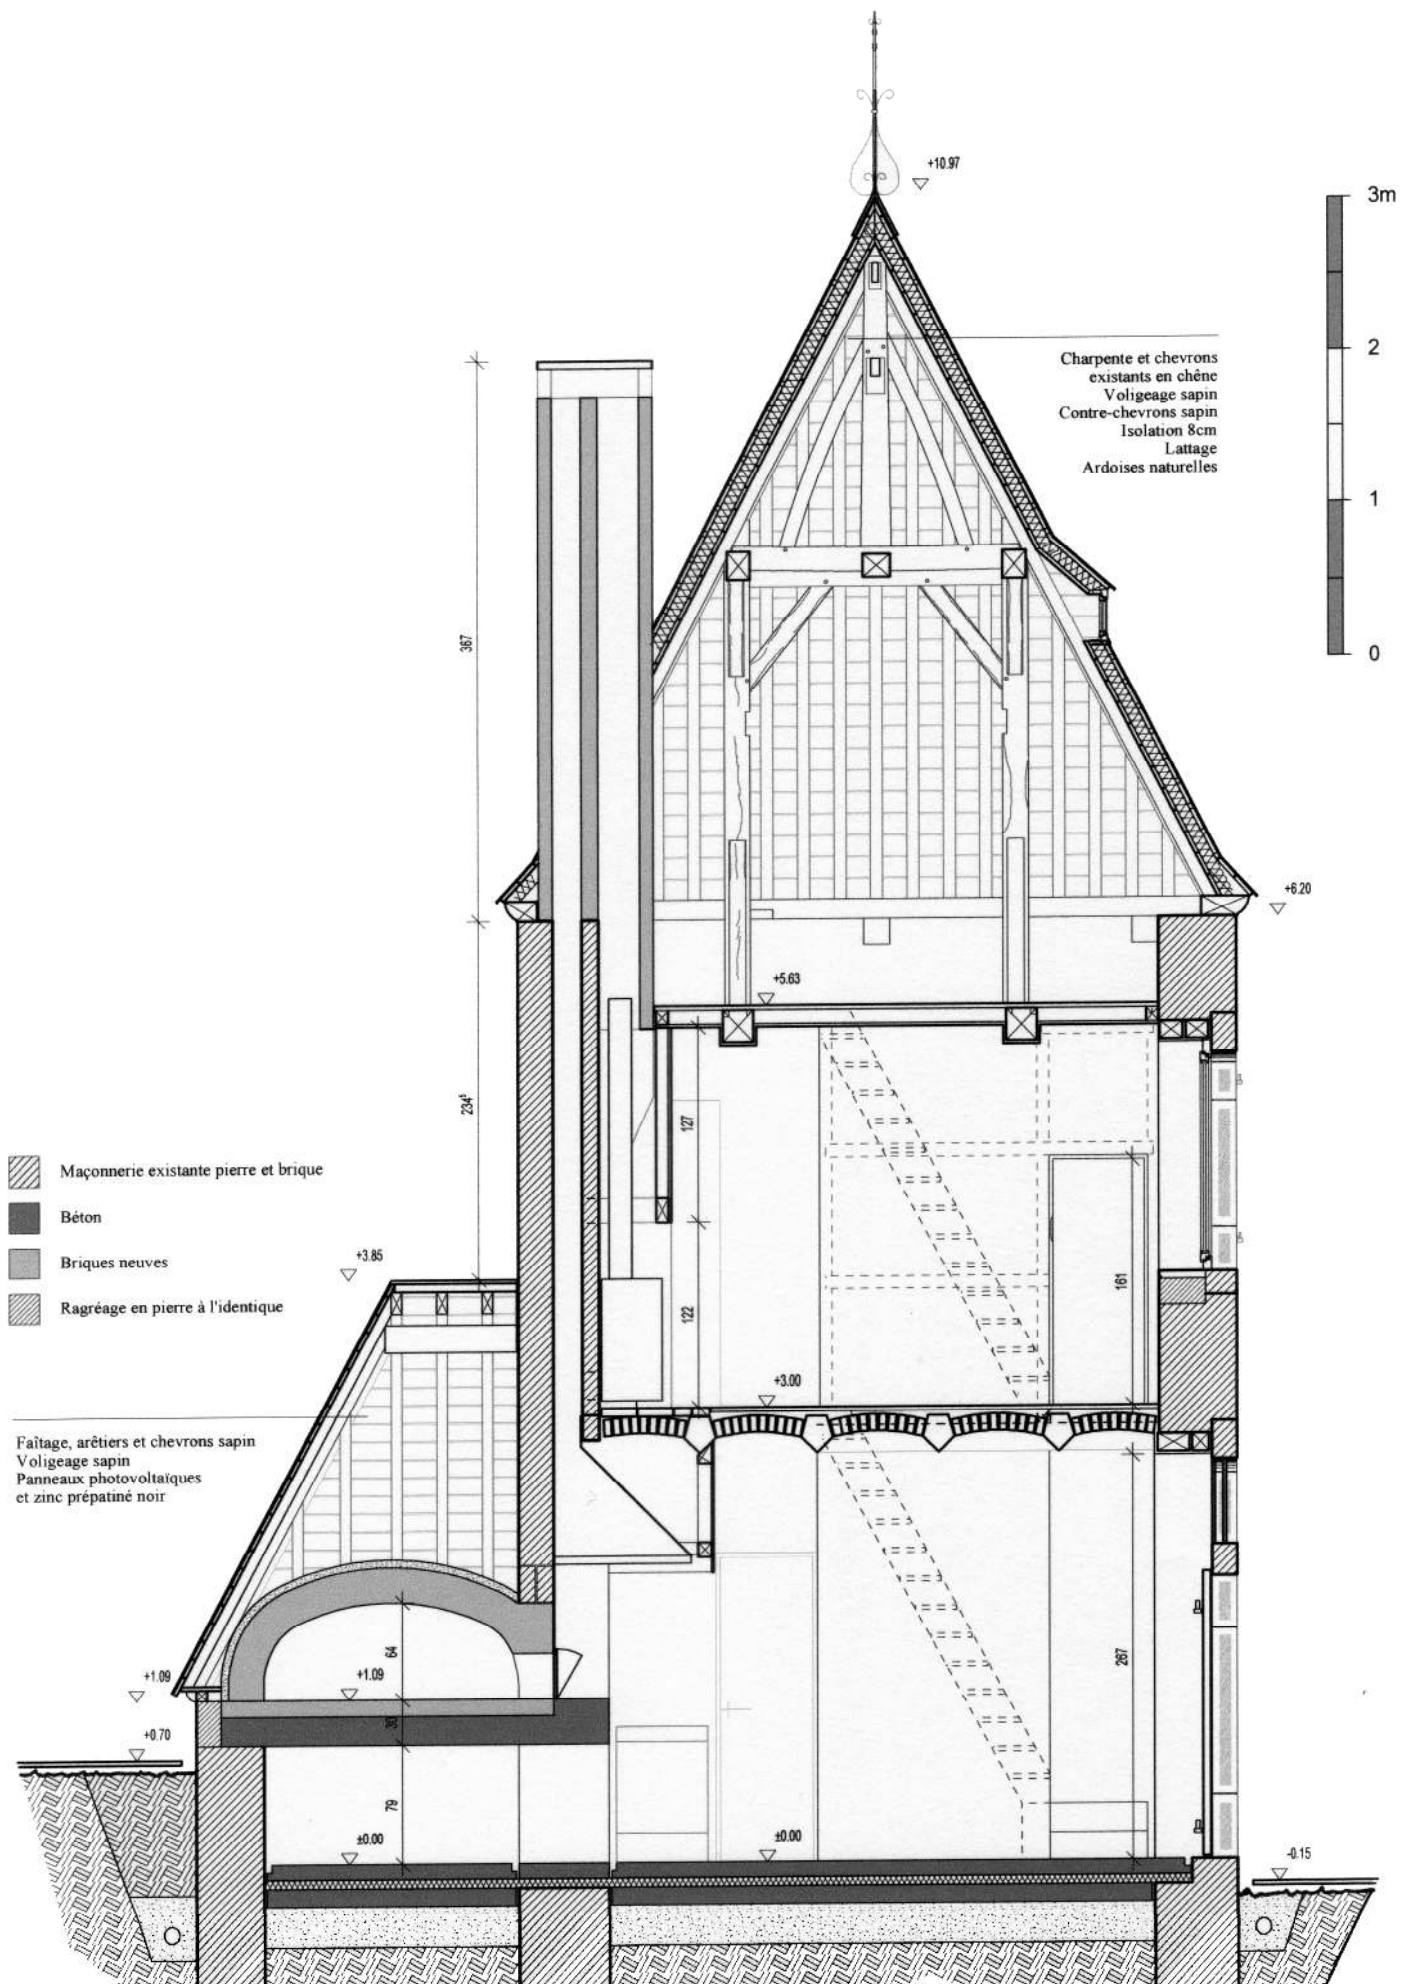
Pavillon et four. Vue en coupe BB'. Ech. 1/50°. Situation projetée. IG 2008.
